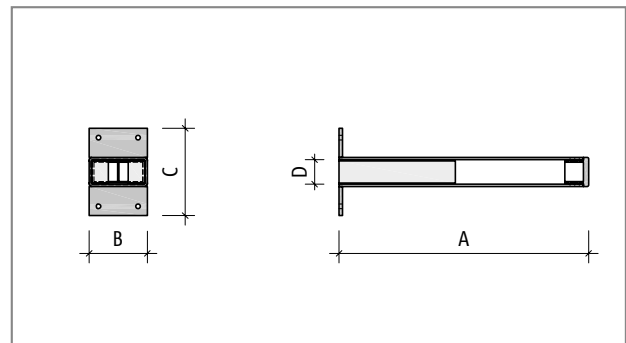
Schöck Dorn type LD-Q Part S : Dimensions de la douille déplaçable transversalement
